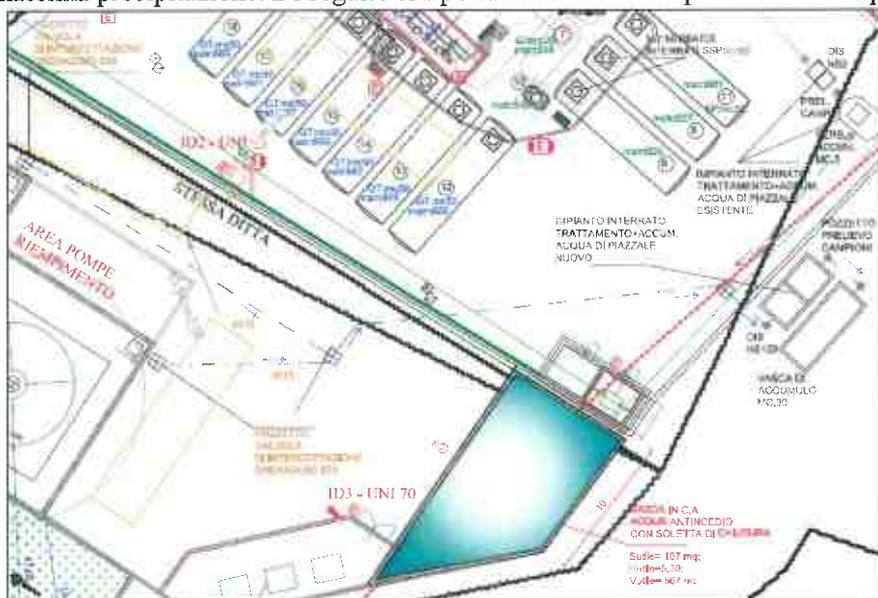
Impianto di drenaggio e trattamento acque di piazzale (da Elab. T7 allegato allo SPA)
